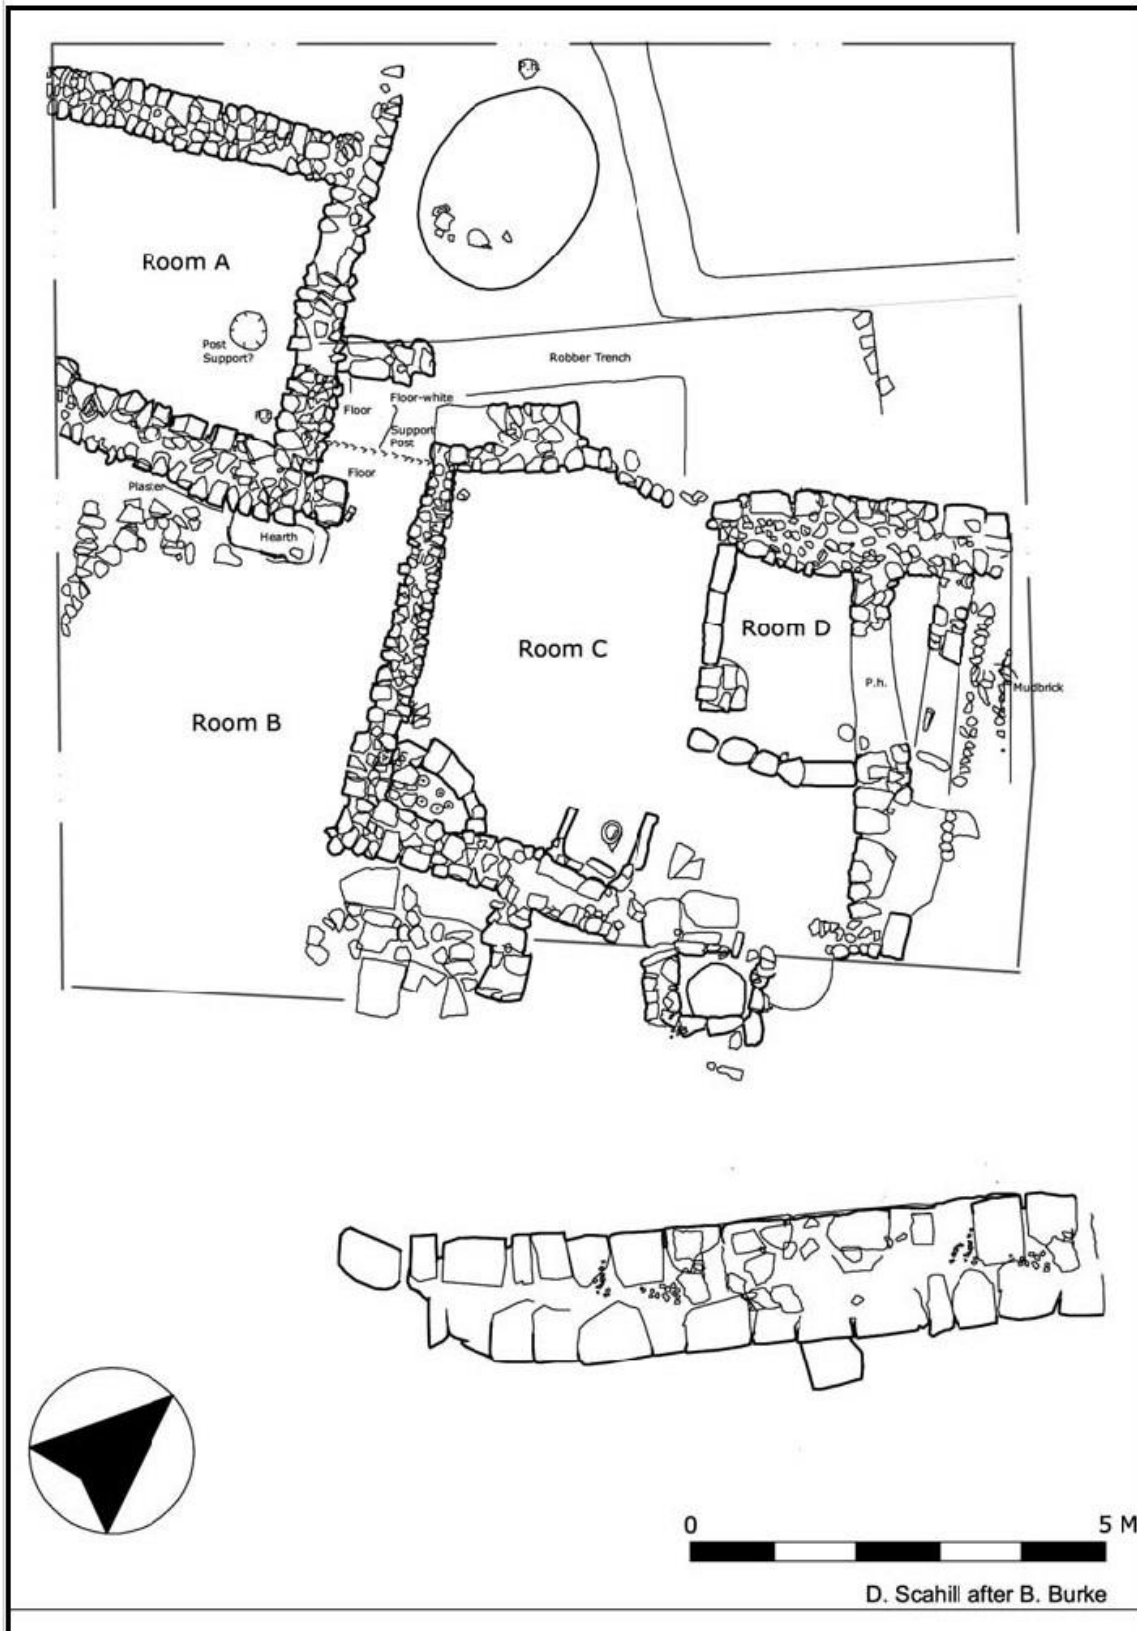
Relevé du secteur sud-est avec vue en plan de la structure 9 (room A), 10 (room B) et 11 (room C et D) (Sams, Burke, Goldam, 2006).
